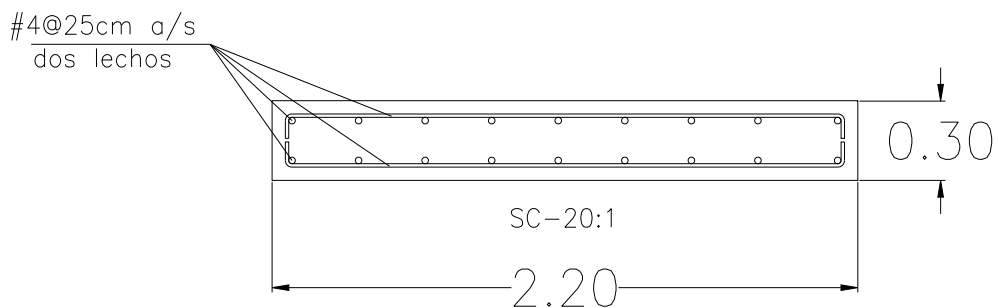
Detalles de acero de refuerzo de zapata de muro
